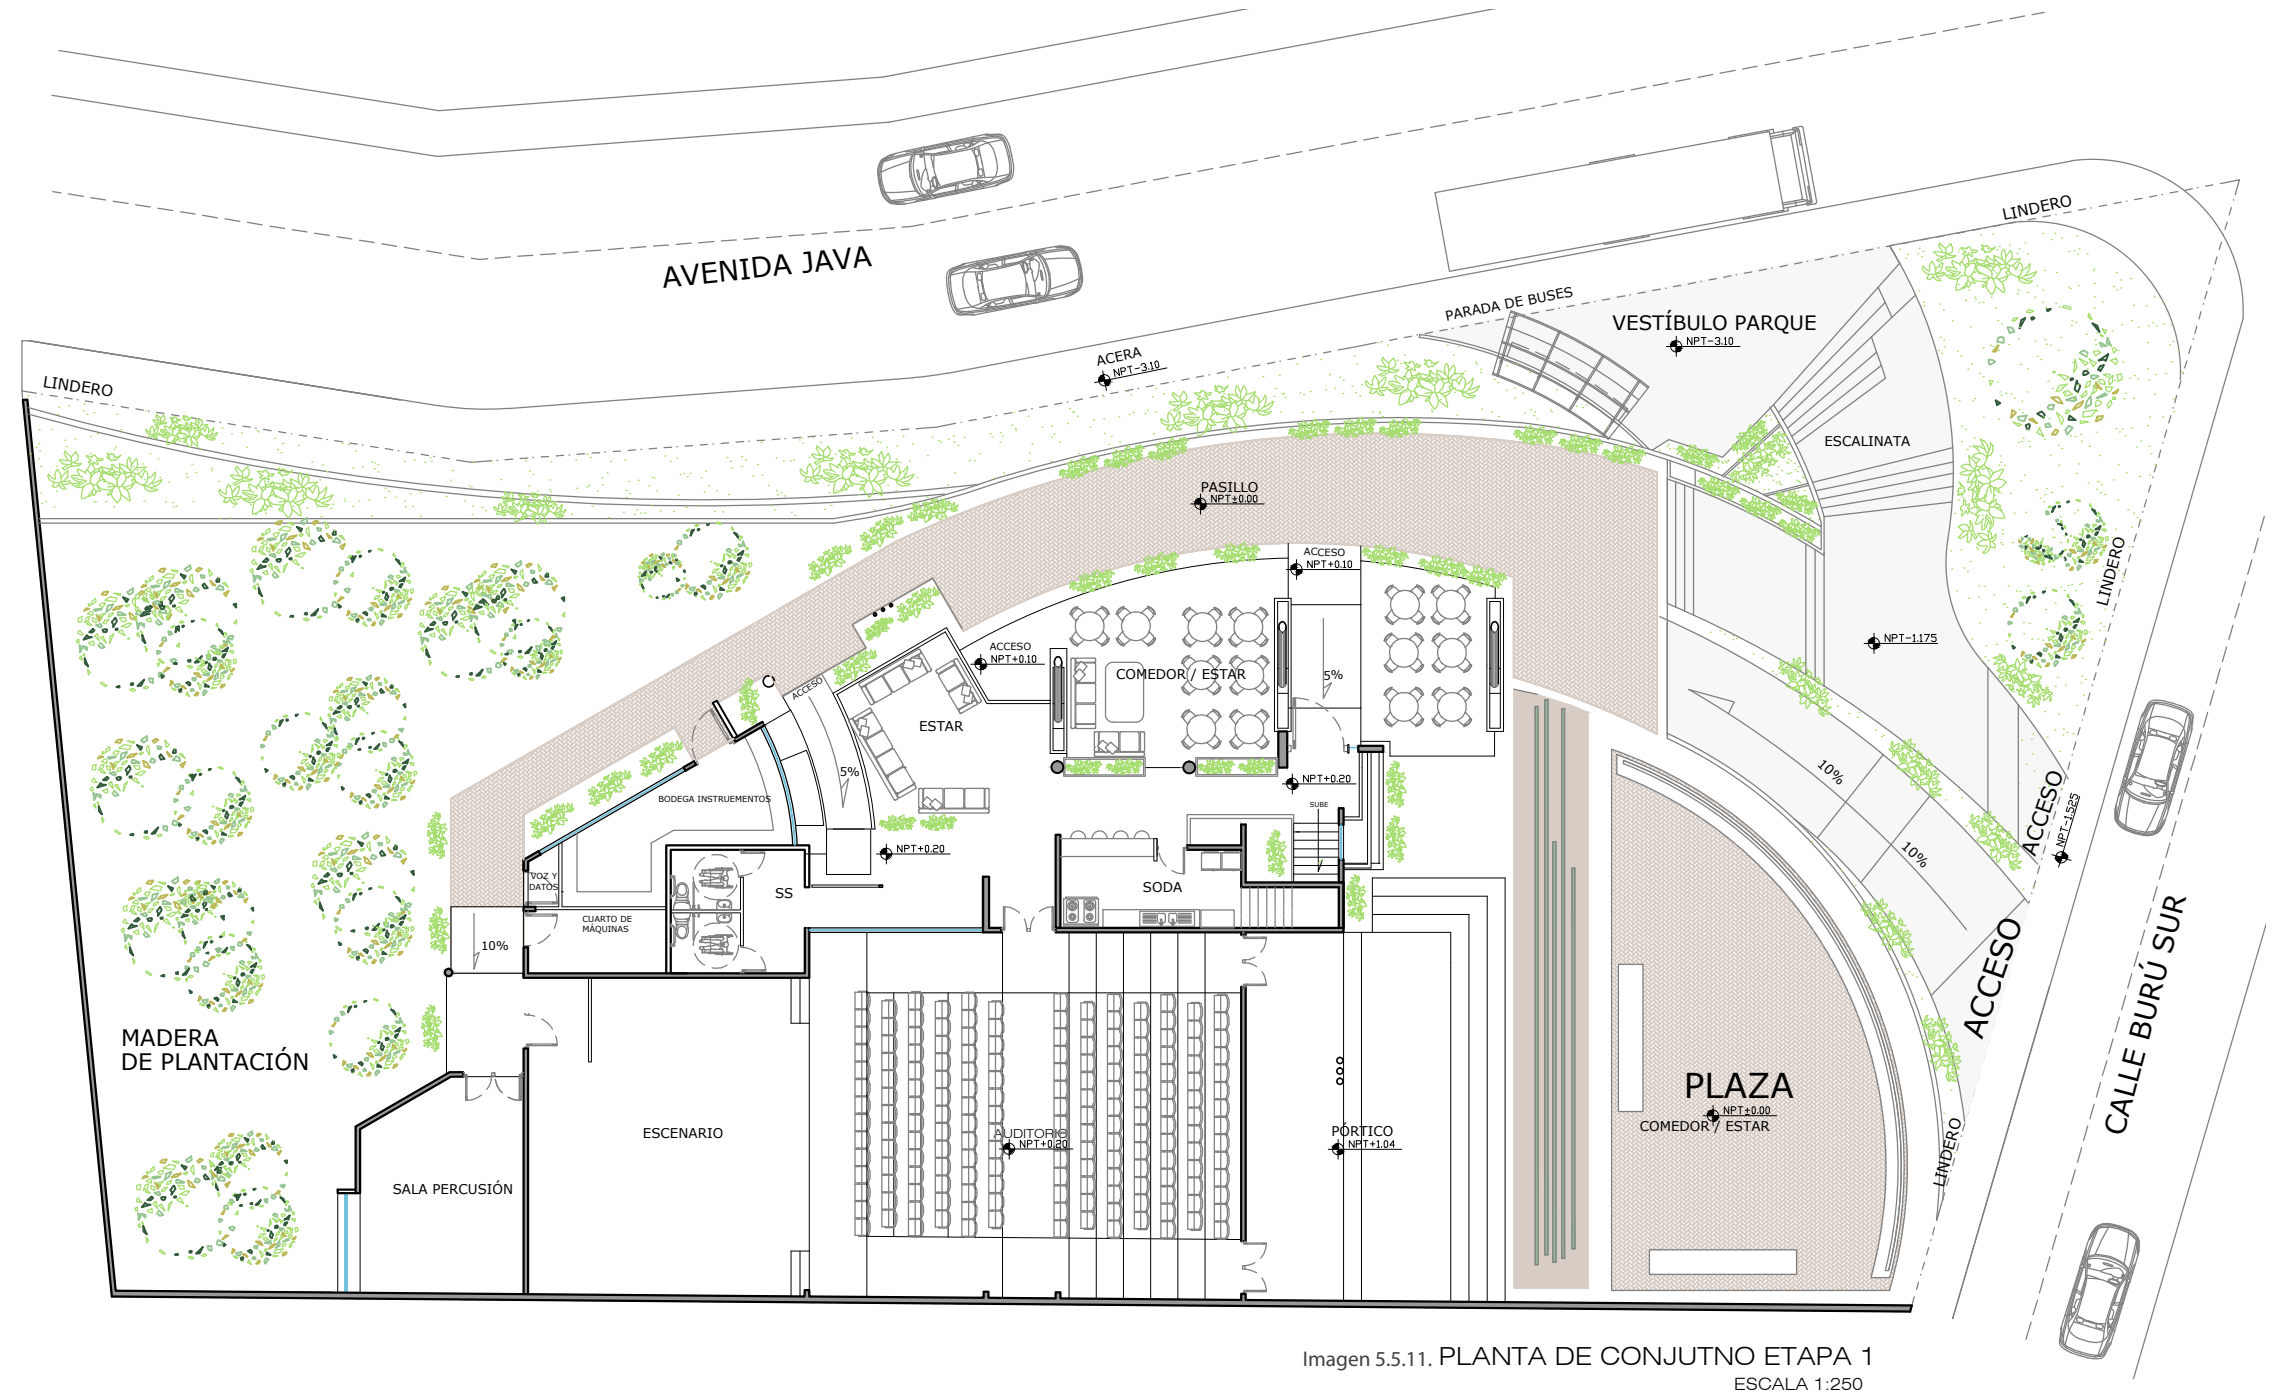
PLANTA DE CONJUTNO ETAPA 1
